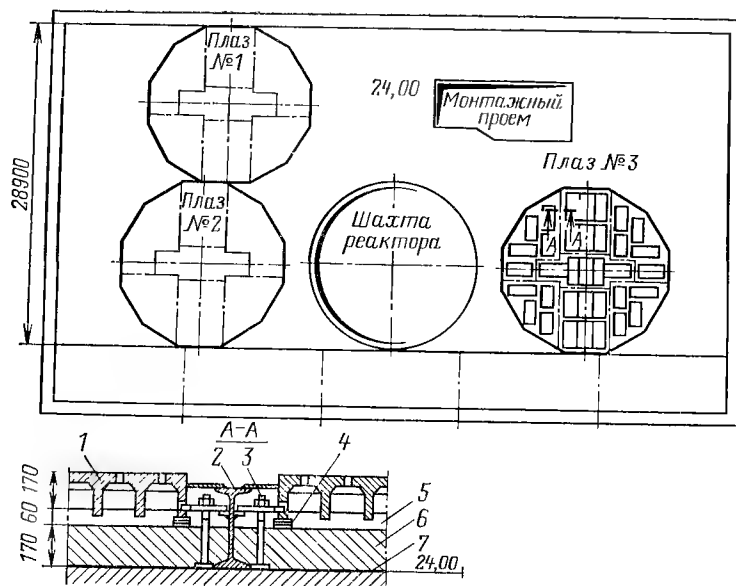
Схема расположения плазов в реакторном цехе.
